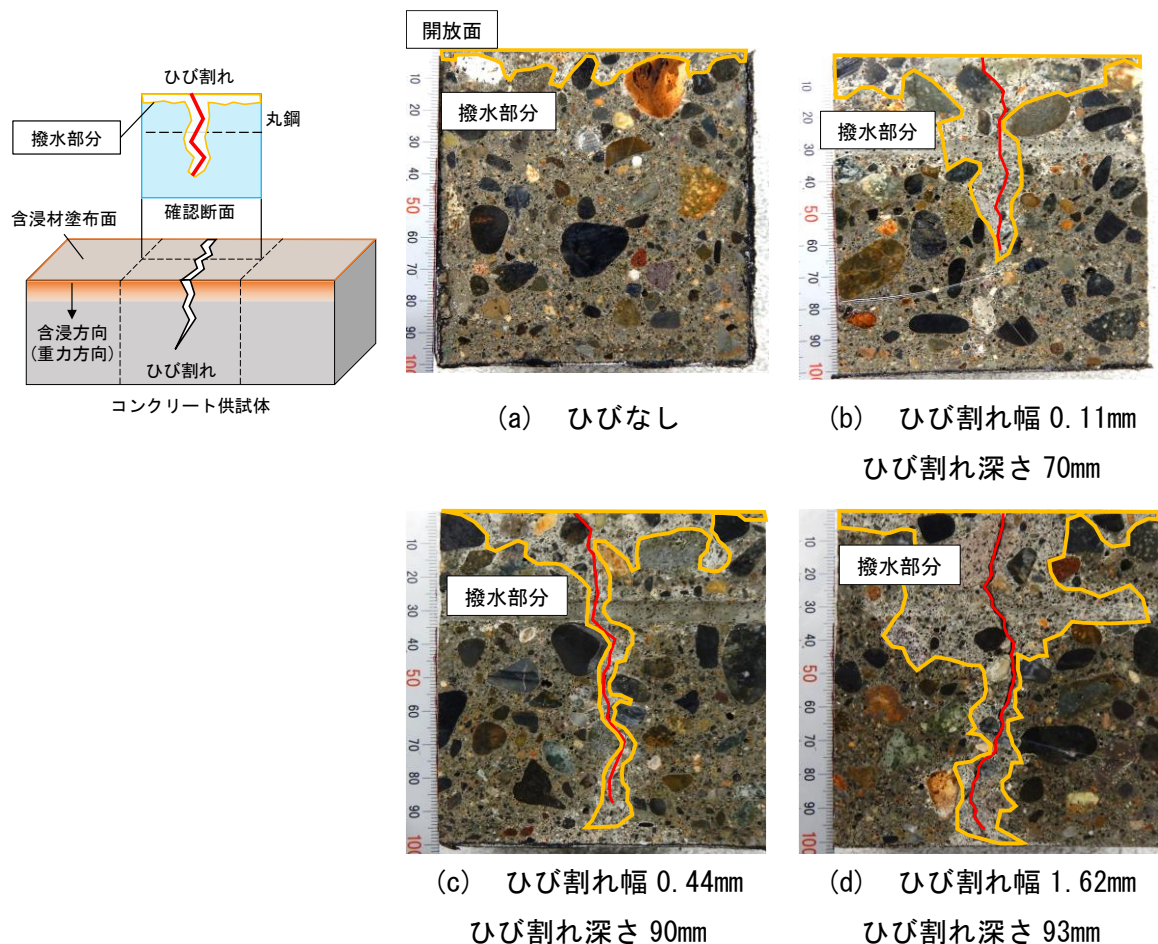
ひび割れを有するコンクリート断面の撥水状況
